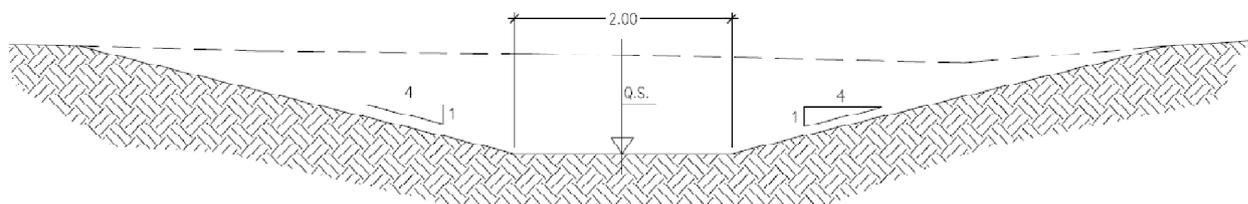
Sezione tipica del canale FC6 di recapito verso sudest
